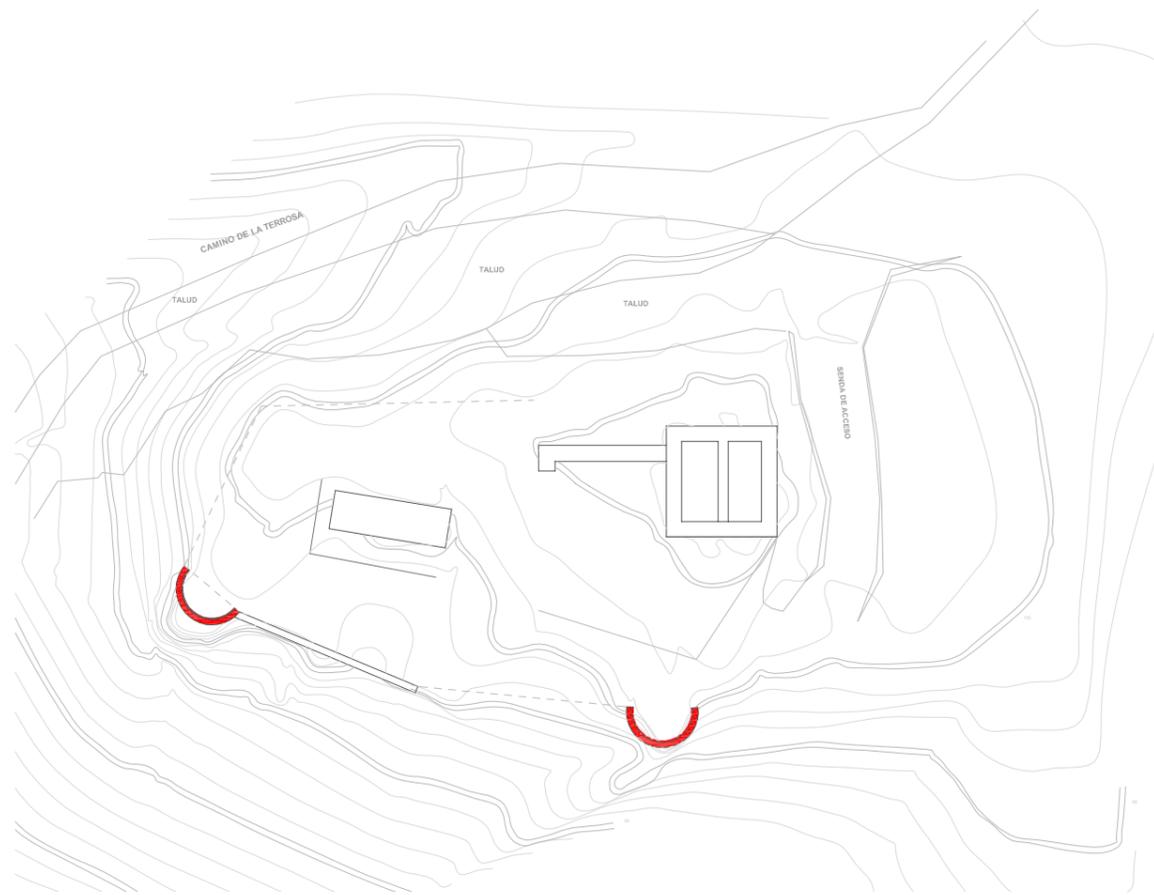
Plano en el se marca las edificaciones de mampostería.
